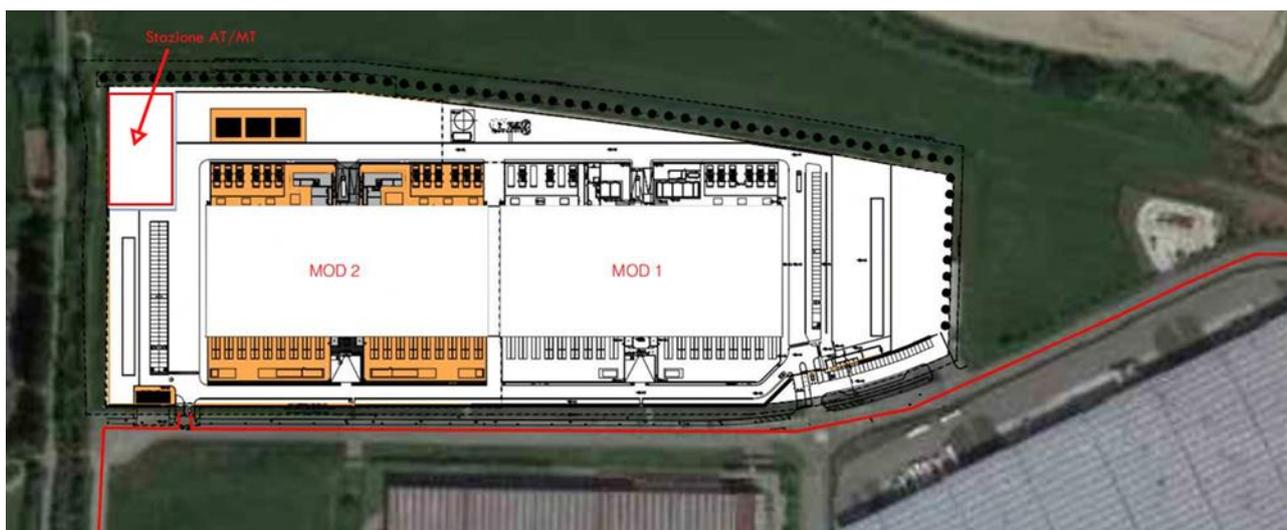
Estratto Planimetria generale mod. 1 e mod. 2
